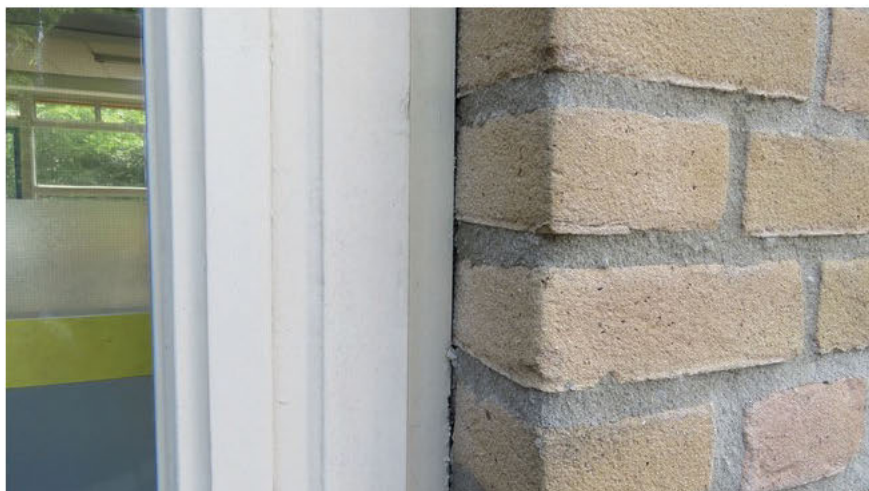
Open stootvoegen in bakstenen geveldeel gebouw A.
